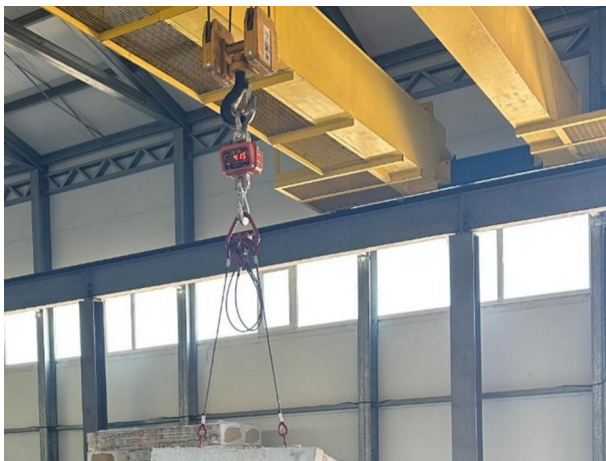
Контрольное взвешивание бетонных блоков перед загрузкой
